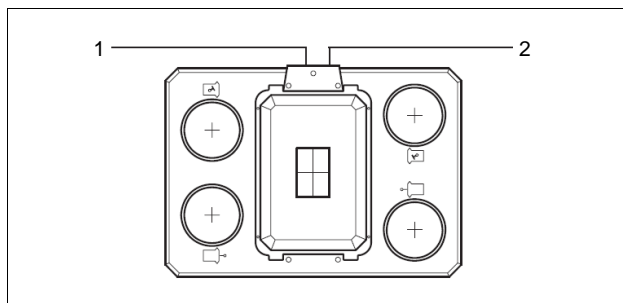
Kabeleinführung Lüftungsgerät (Ansicht von oben)
